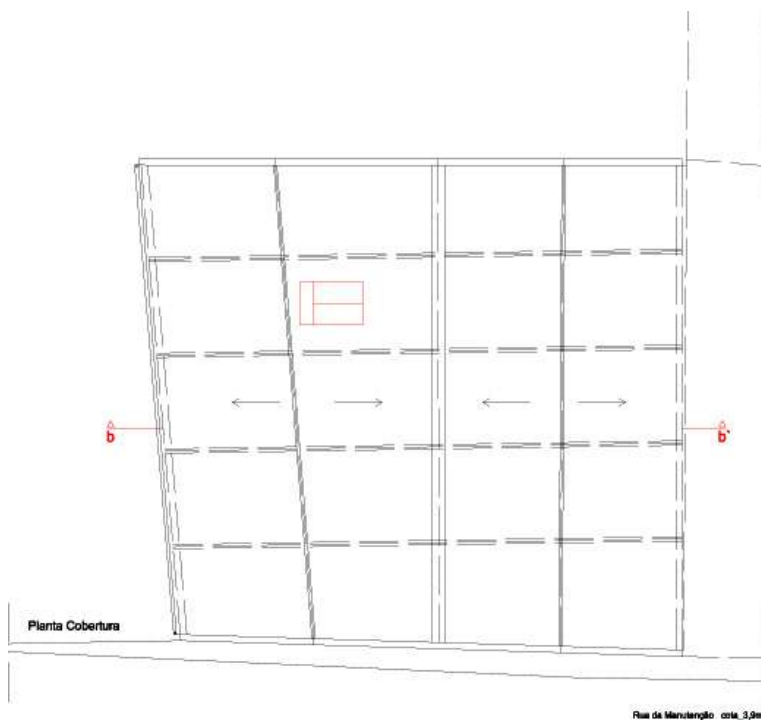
Planta de Cobertura com a marcação do Corte transversal bb', dos armazéns n.ºs 82 e 84 da Rua da Manutenção. Por Sofia Neves
